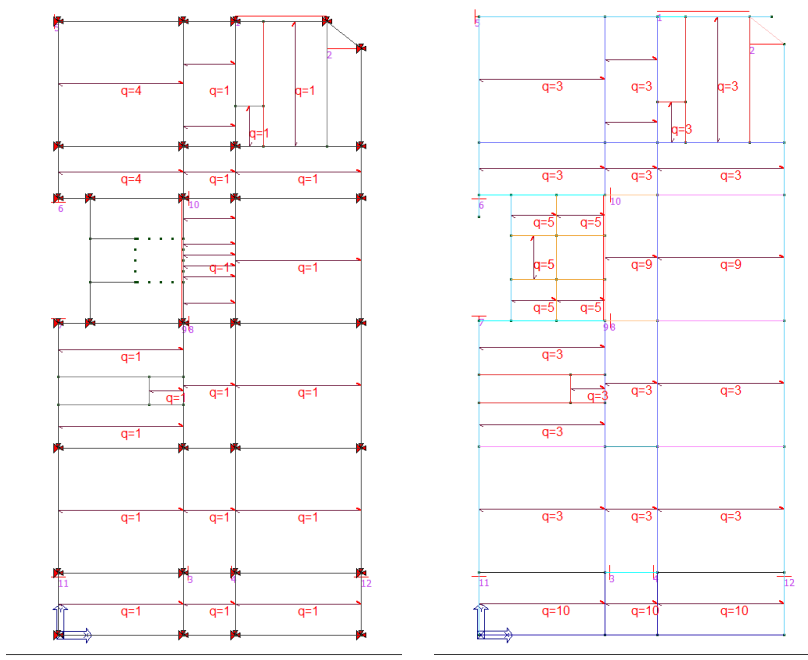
pianta solaio con indicazione tipologia solaio – pianta piano seminterrato e terra
